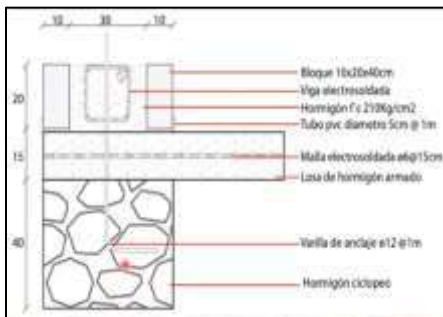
Propuesta de cimentación para la construcción de una casa con fardos de paja.
